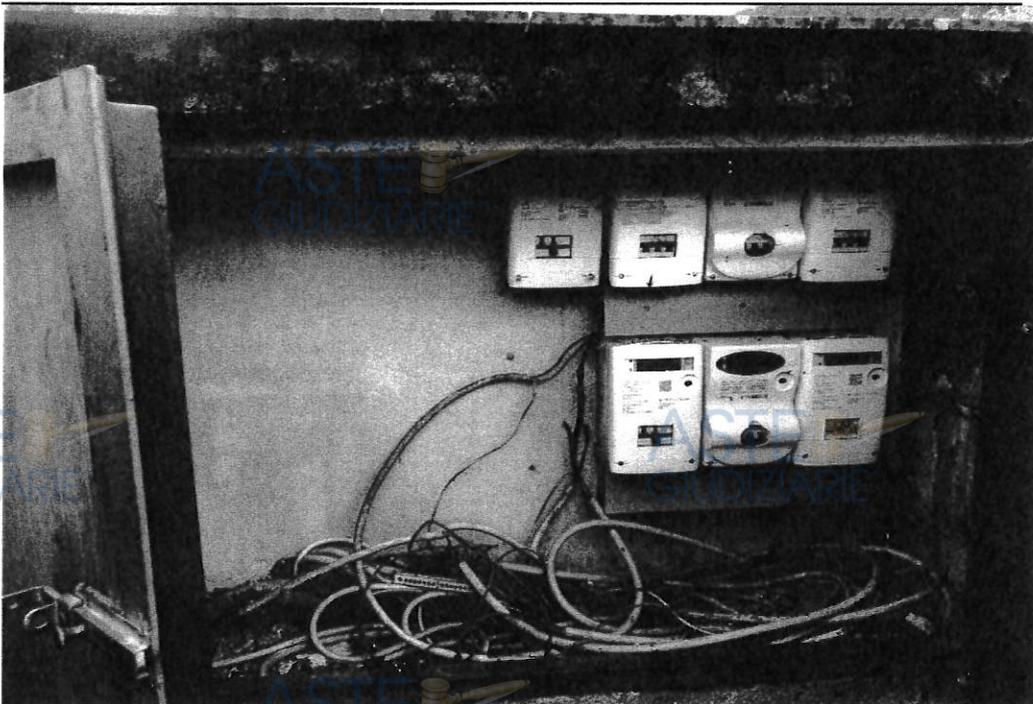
vano dei contatori dell'energia elettrica posto nella parte esterna del muro di confine sul lato sinistro dell'ingresso dal parcheggio pubblico
